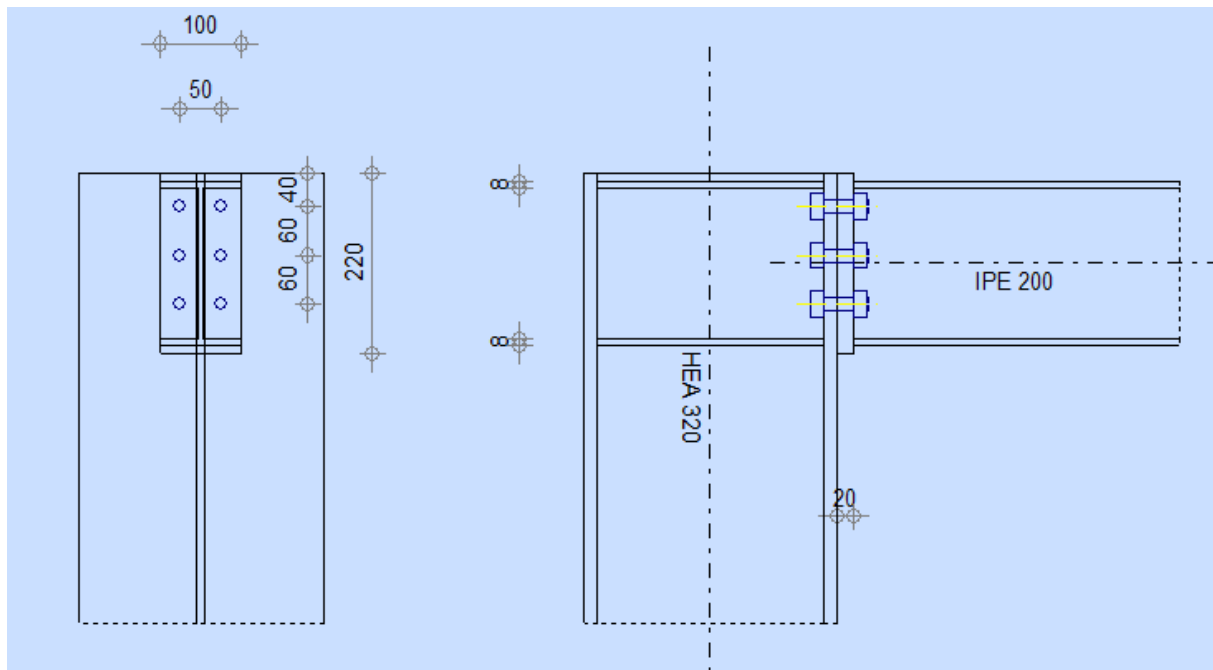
Représentation de l'assemblage Poteau-Poutre secondaire.
